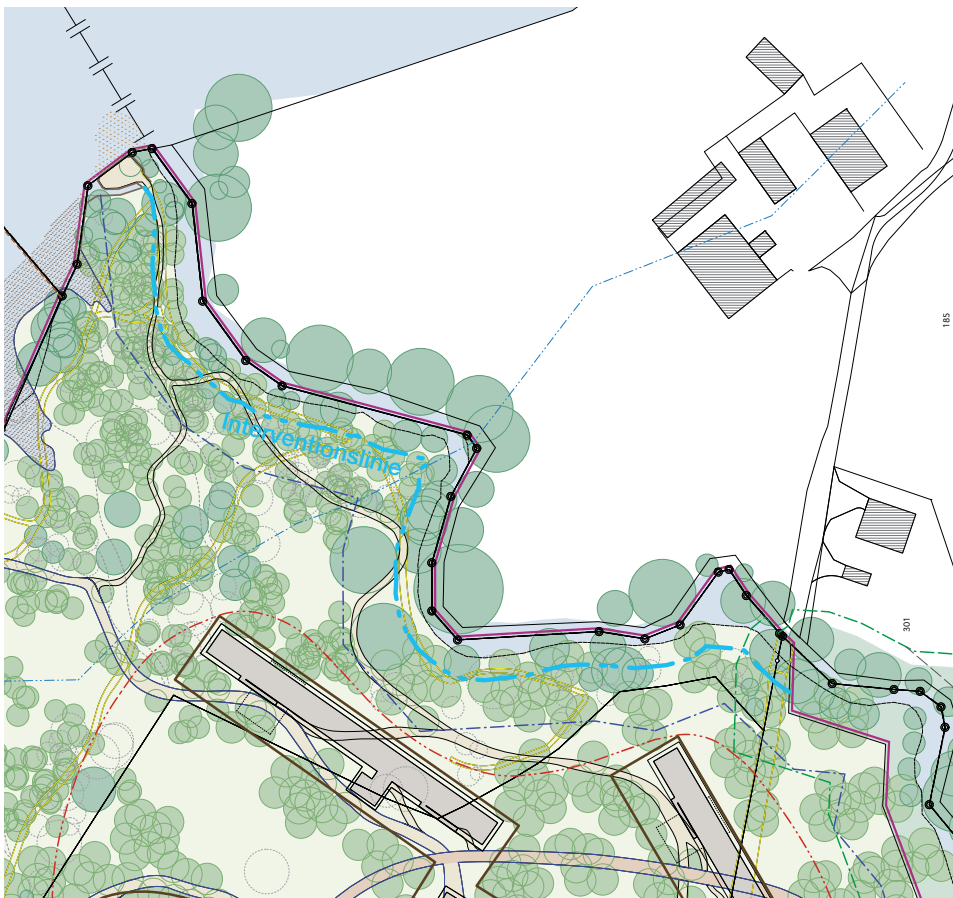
Ausschnitt Bebauungsplan, Interventionslinie Aabach
